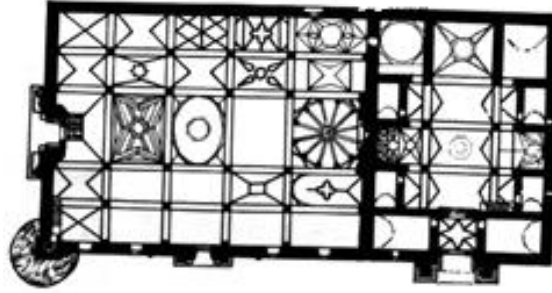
Silvan Ulucami Plan Şeması [16]
